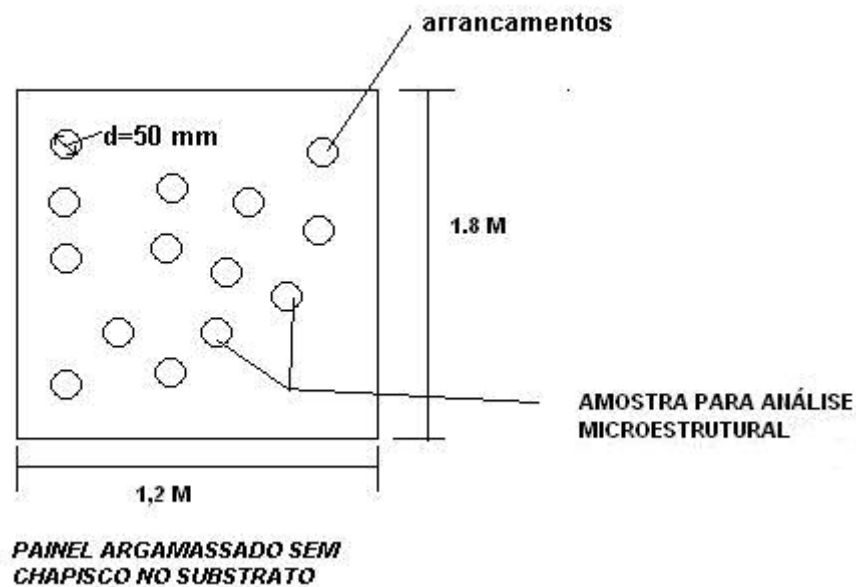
Croquis dos painéis de alvenaria executados.
